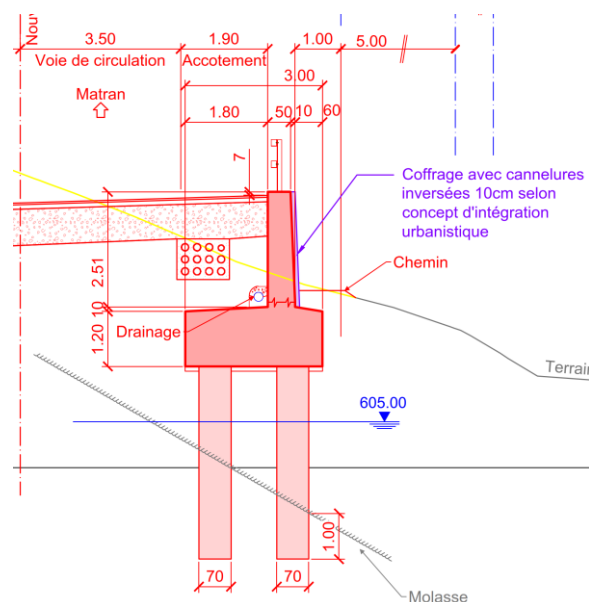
Section type du mur des Fontanettes aval avec semelle fondée sur pieux
